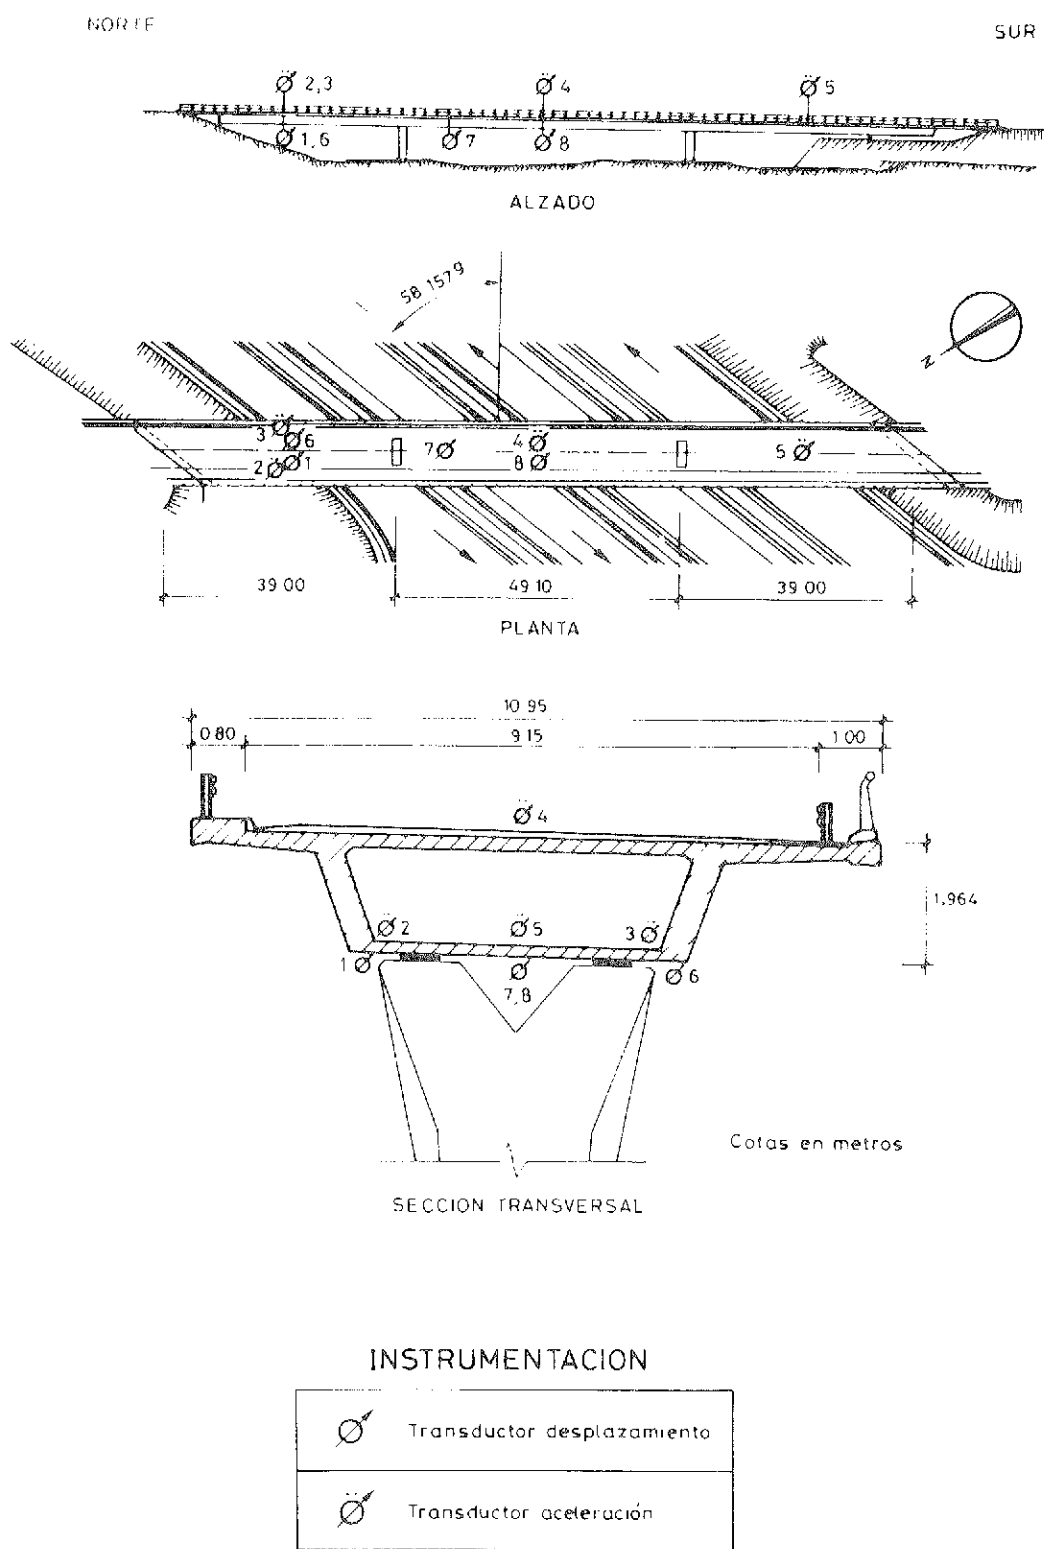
Planta general, sección transversal e instrumentación utilizada.
